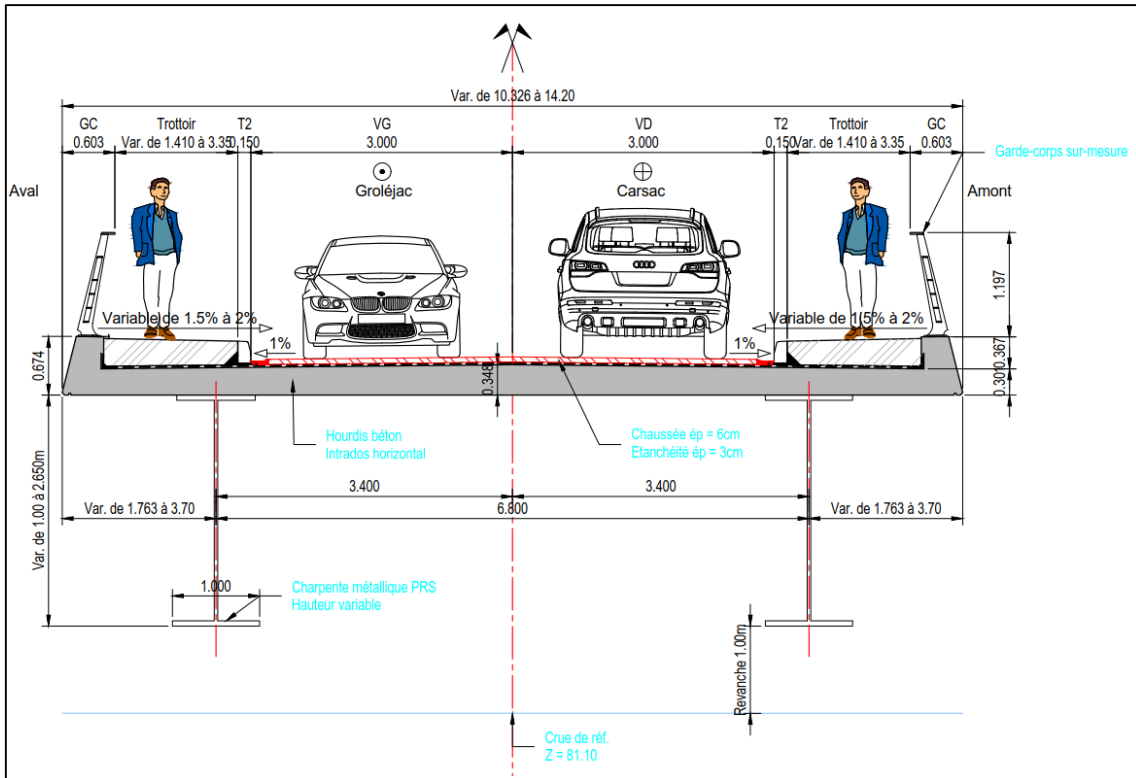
Coupe transversale de l'ouvrage définitif (Source : Arcadis)
